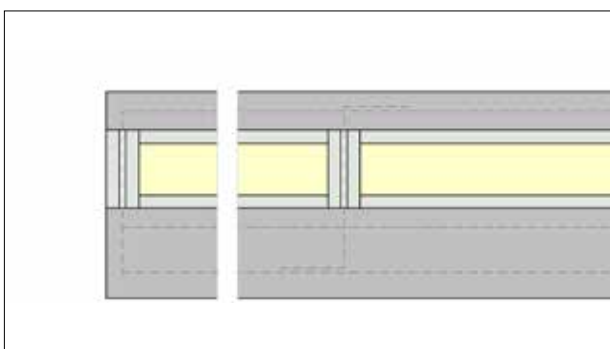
Fassaden-Sandwich-elemente (FSE), Aufbauvariante (kbp)
